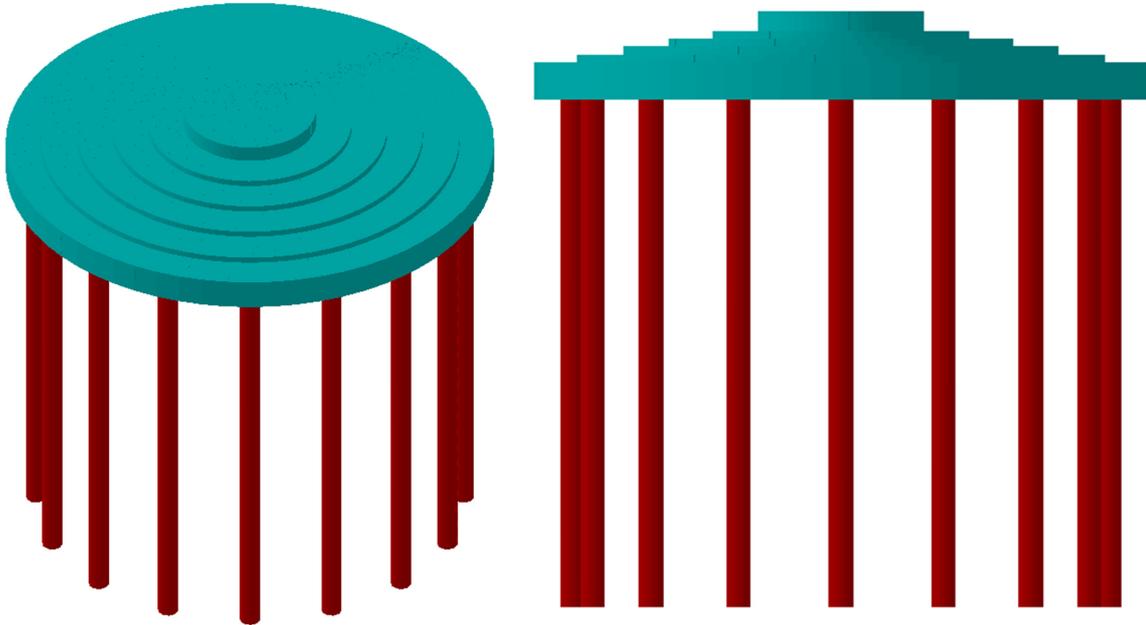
Vista 3D e vista XZ fondazione tipo.
